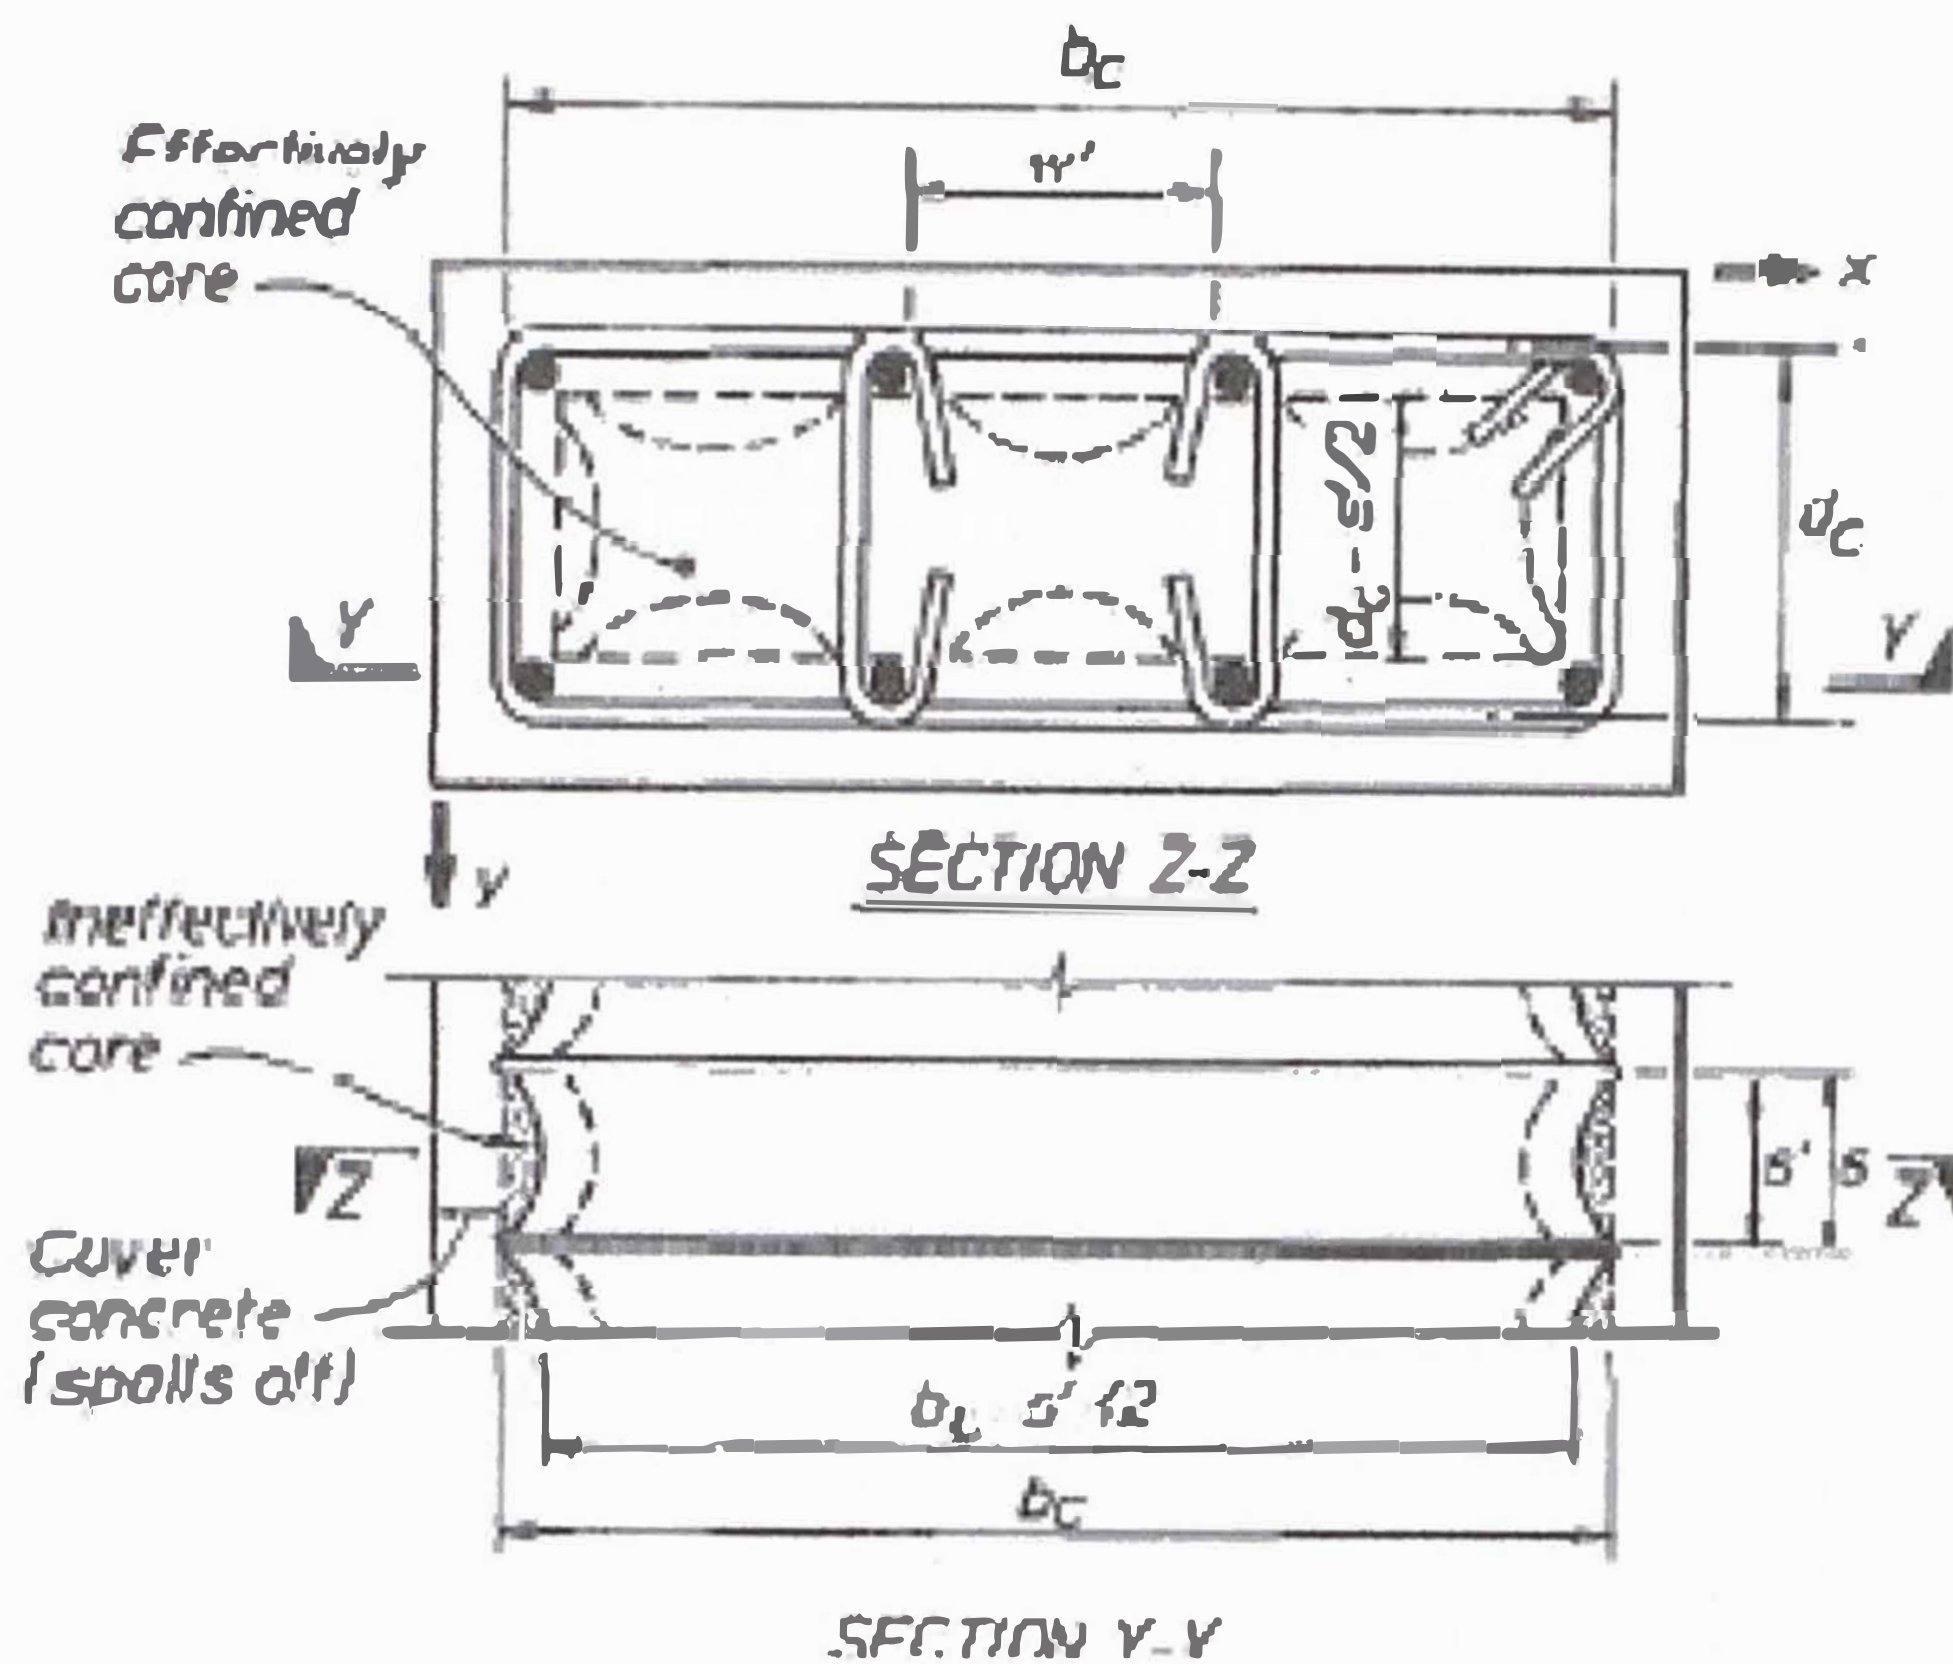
Areas no confinadas por estribos en planta y elevacion
